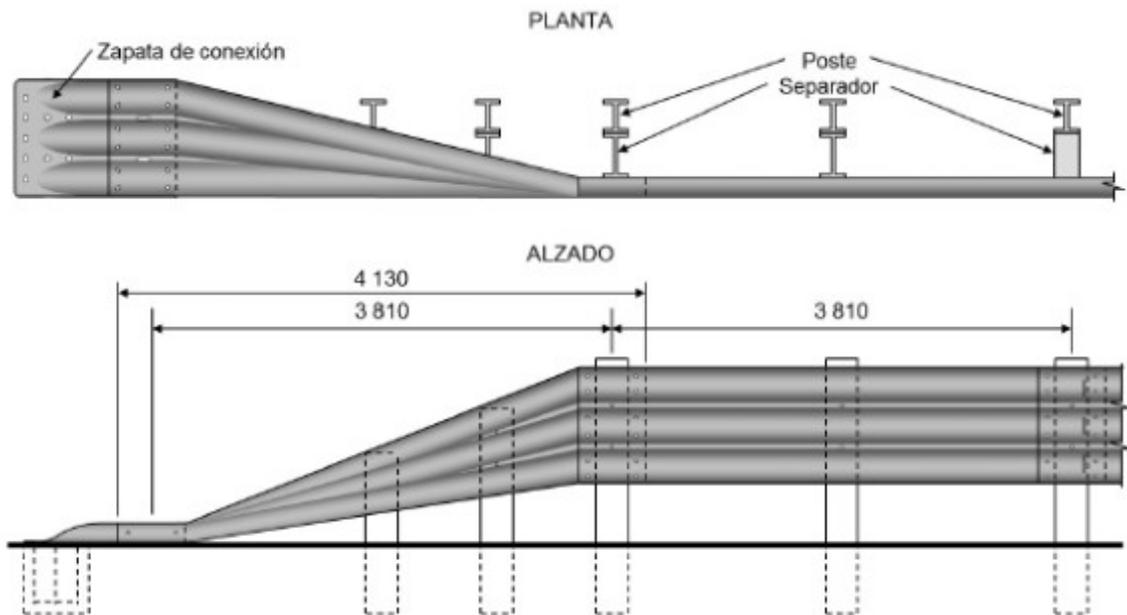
Sección terminal aterrizada para vigas acanaladas de dos y tres crestas (OD-4.4.2/A)
